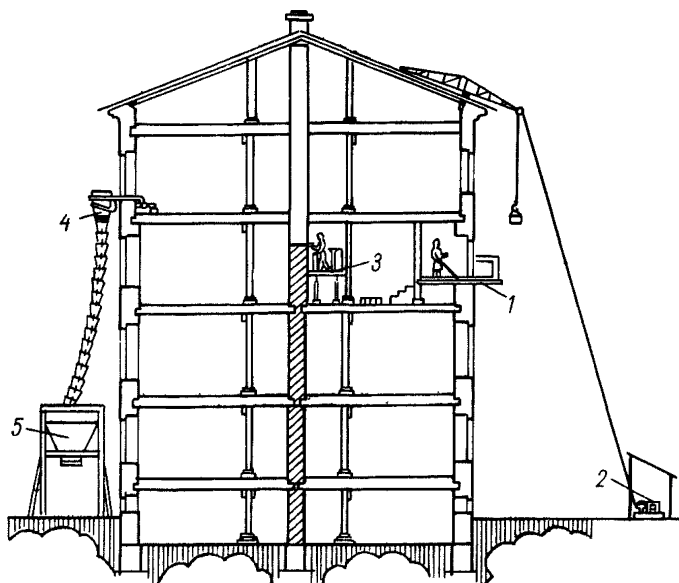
Общая схема организации работ по перекладке участка стены с сохранением существующих перекрытий
